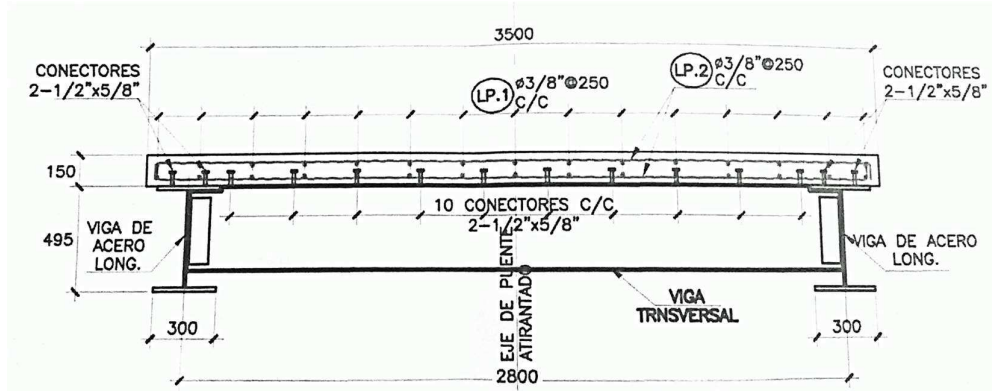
Sección transversal de puente en tramo atirantado en viga transversal.
